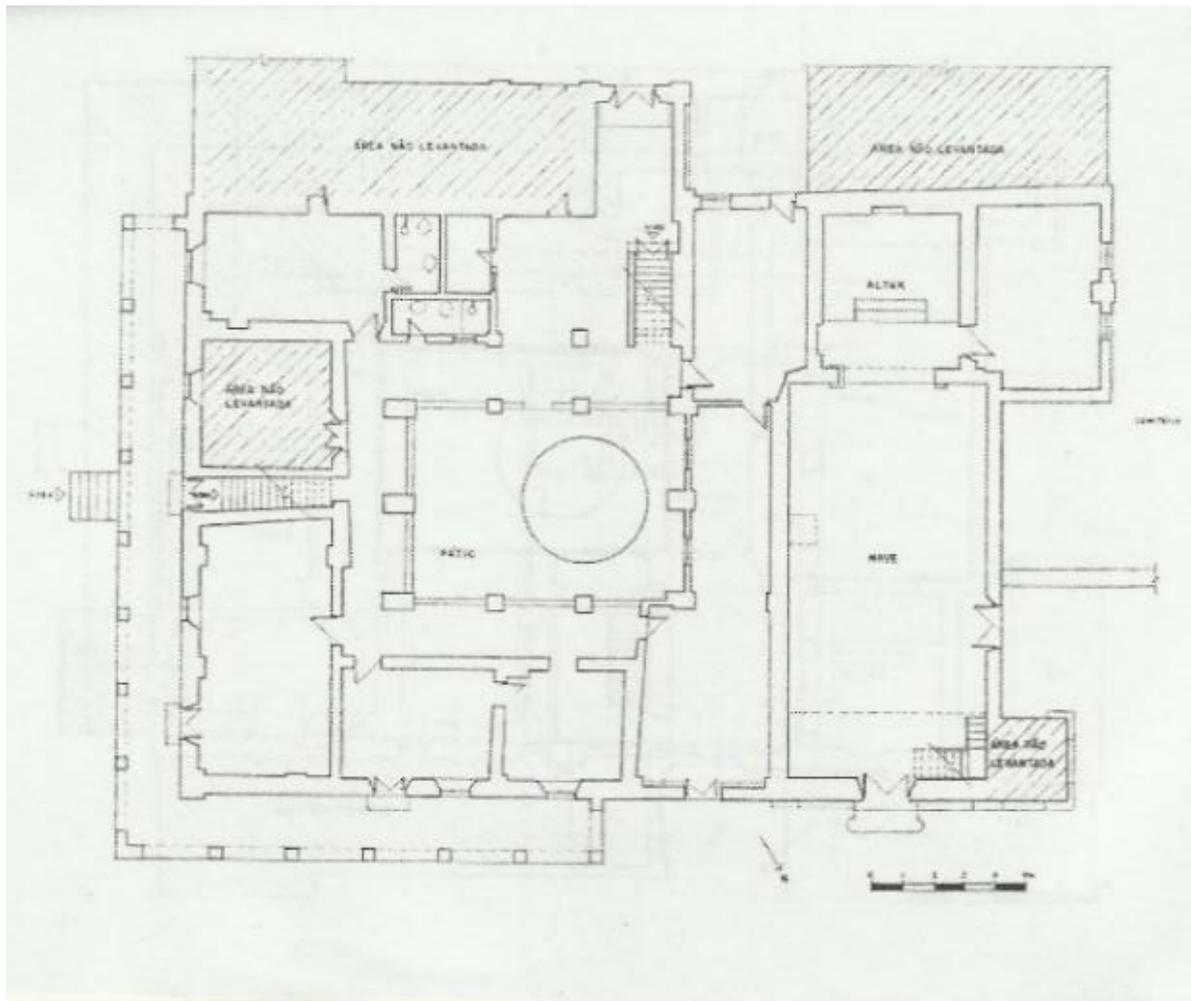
Planta da quadra e do pátio da Fazenda Campos Novos. Reprodução da Planta baixa do Primeiro Pavimento da Fazenda Campos Novos – 1690 - Cabo Frio – RJ – Levantamento realizado por José Antônio Andrade ARAÚJO, publicado em A Quadra Perfeita: Um Estudo sobre Arquitetura Rural Jesuítica. Niterói. UFF, 2000.
